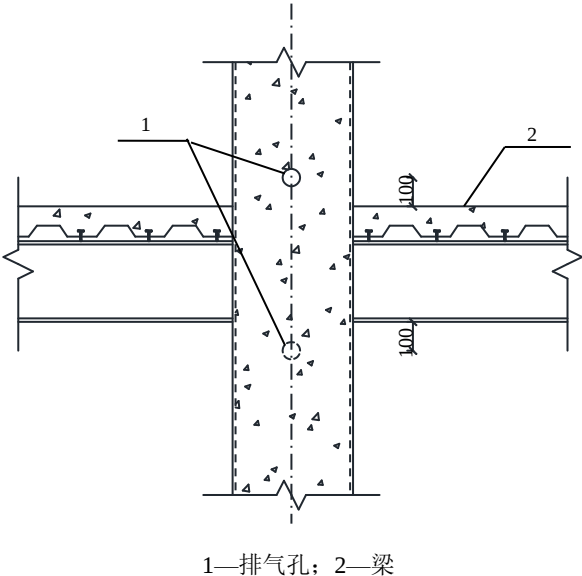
排气孔位置示意图（尺寸单位：mm）
